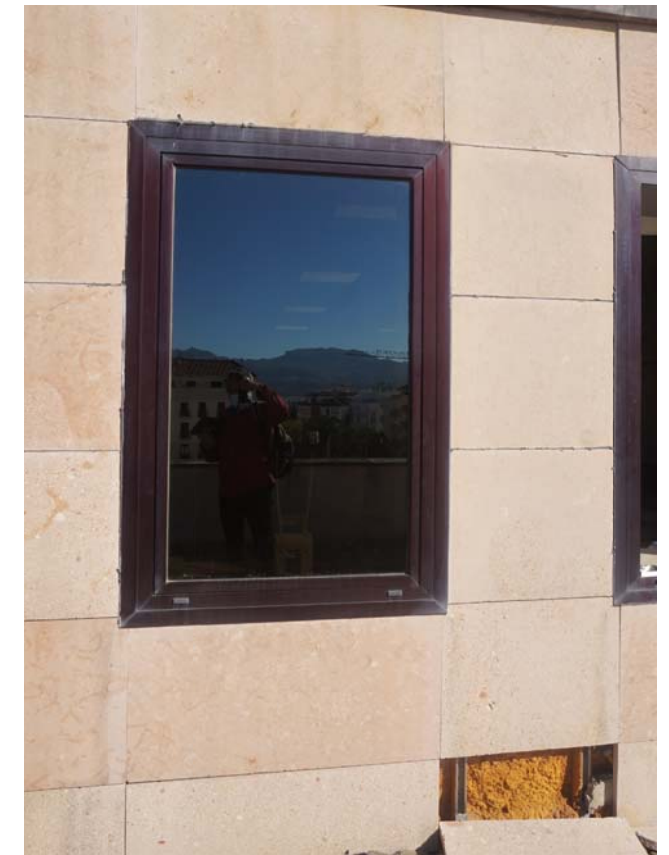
ALINEACIÓN EXTERIOR DE CARPINTERÍAS HASTA ACABADO DE FACHADA
